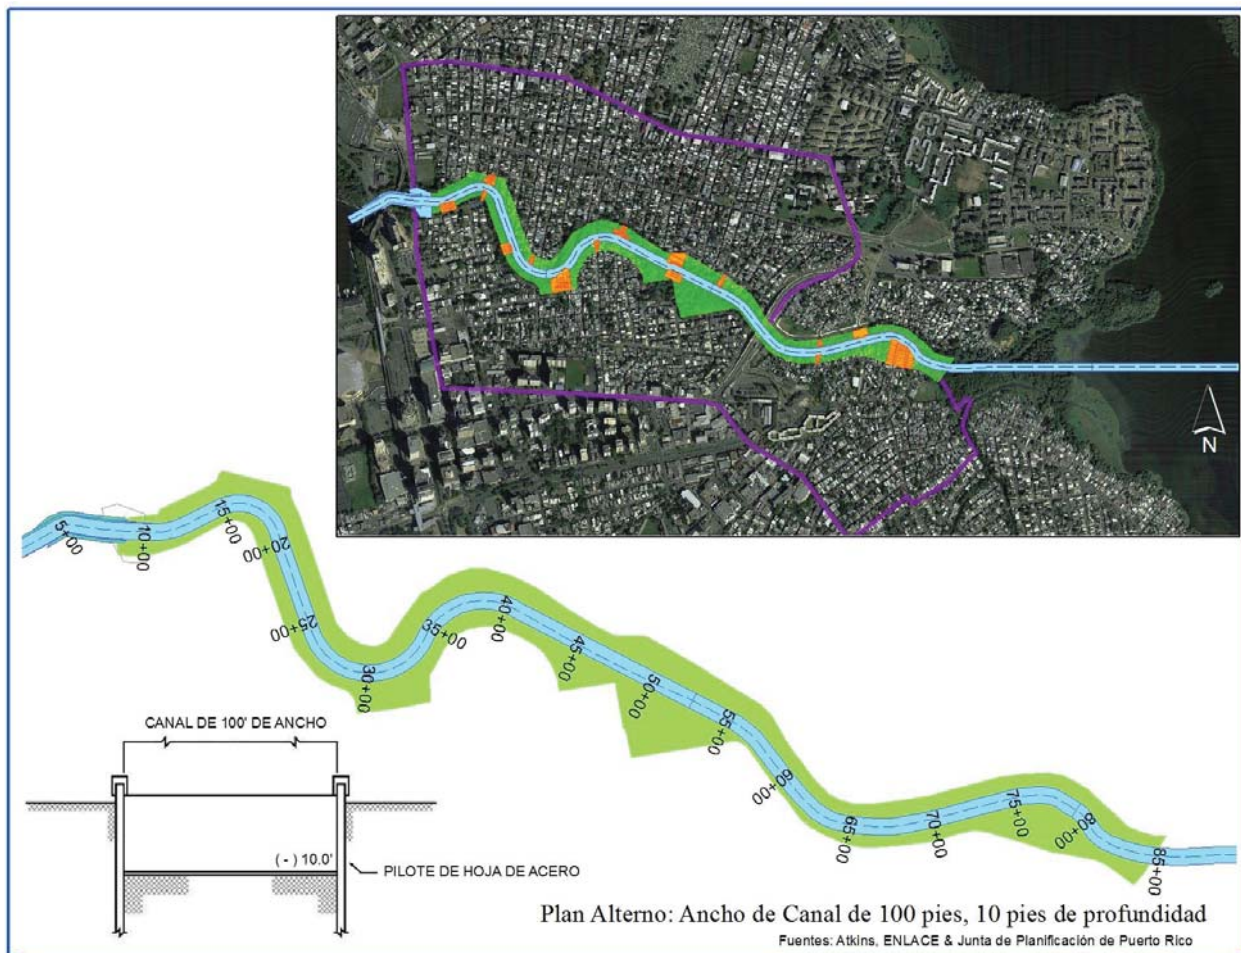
Plan Alternativo 2 – Canal de 100 pies de ancho y 10 pies de profundidad
